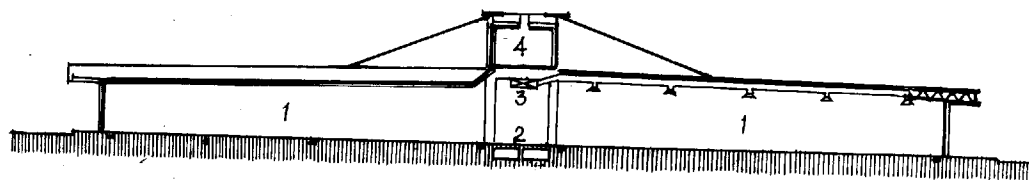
厂房剖面图 1. 无柱的生产车间，进深30米；2. 中央区；3. 主空调管道；4. 钢筋混凝土箱形大梁。
